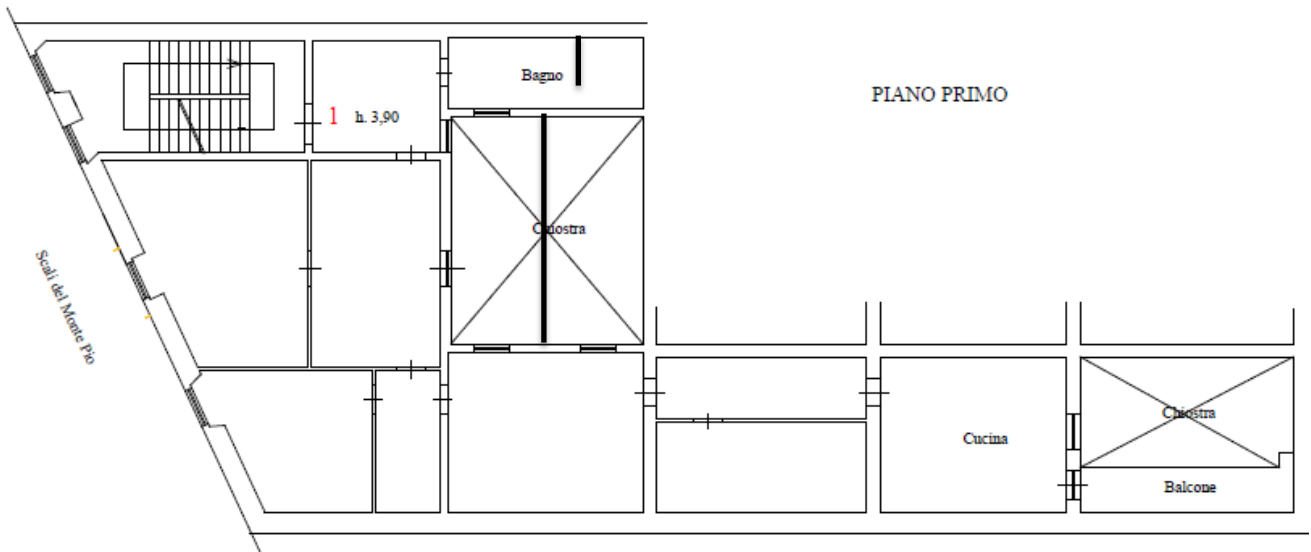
Planimetria dell'appartamento posto al piano primo
